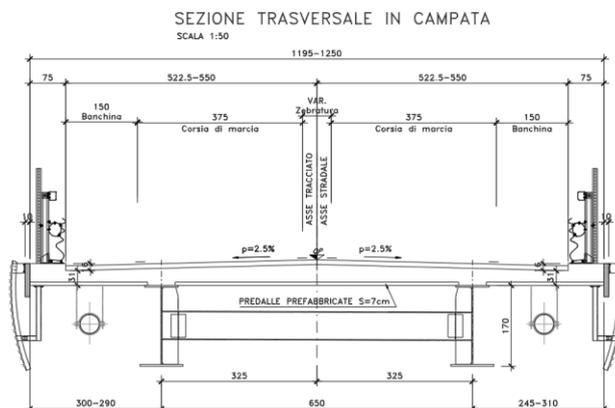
Sezione trasversale Ponte tipo impalcato tipo in campata
